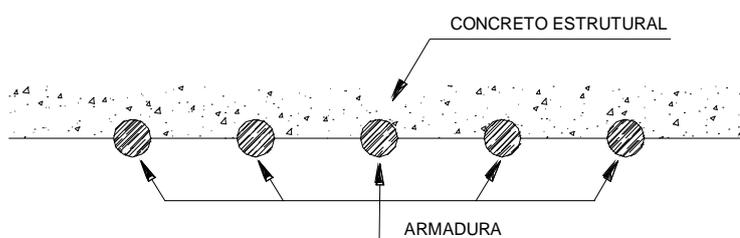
Esquema de Apicoamento Para Recuperação de Armaduras com Corrosão caso necessário.
